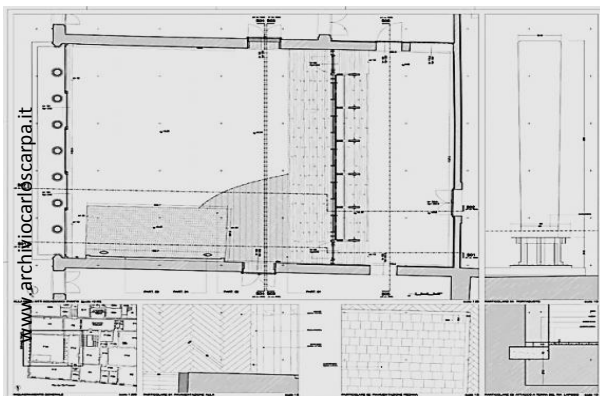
Pianta aula Magna M.Baratto. Dett. Pavimentazione, rivestimento lapideo con portabusti
